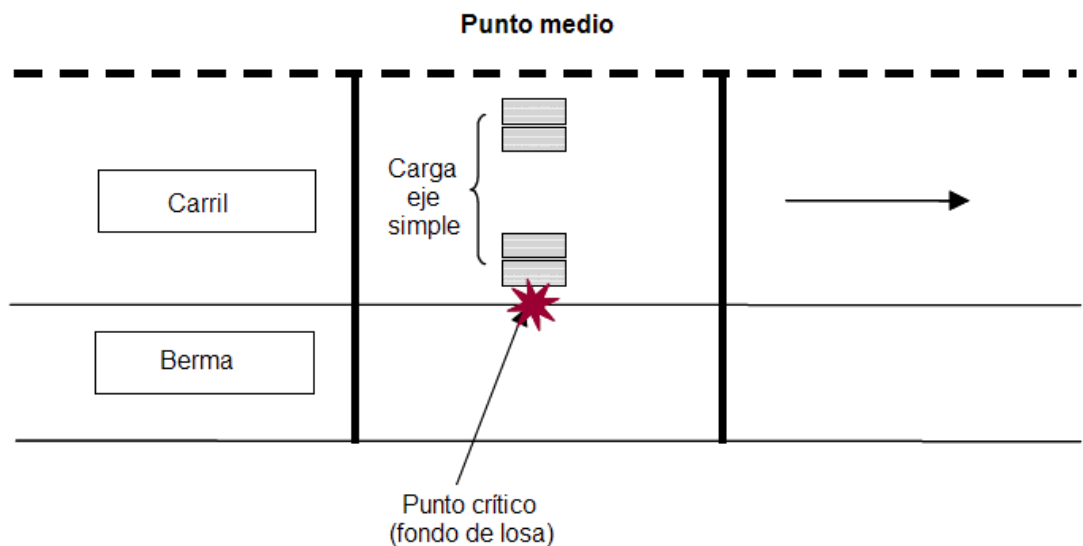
Posición y carga crítica para las fisuras transversales abajo - arriba
